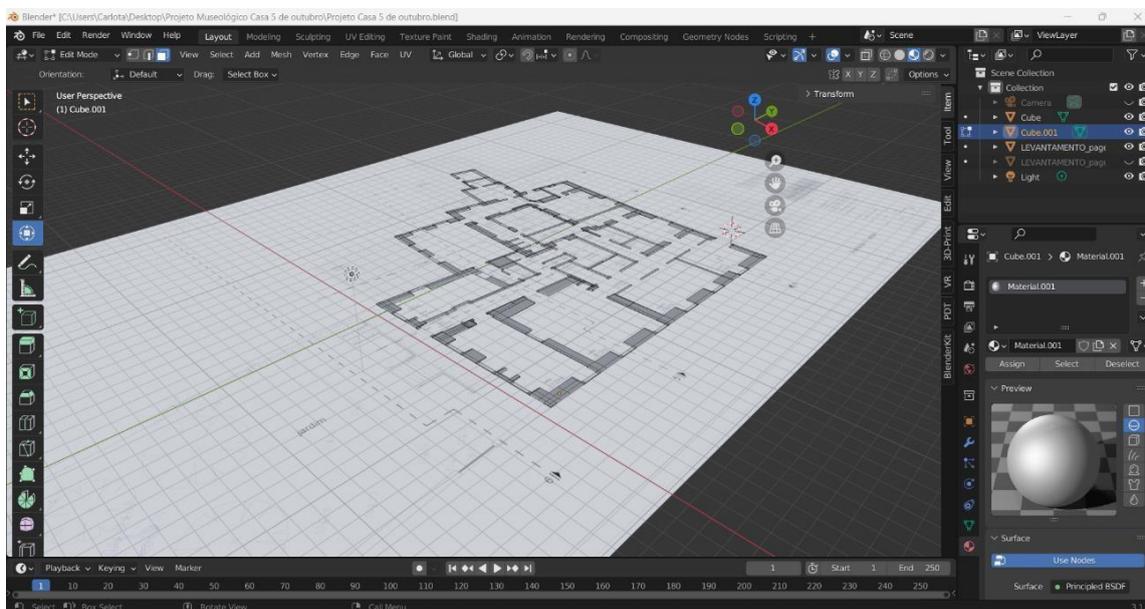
Blender: Início da construção do projeto 3D (©Carlota Silva, 2024)
